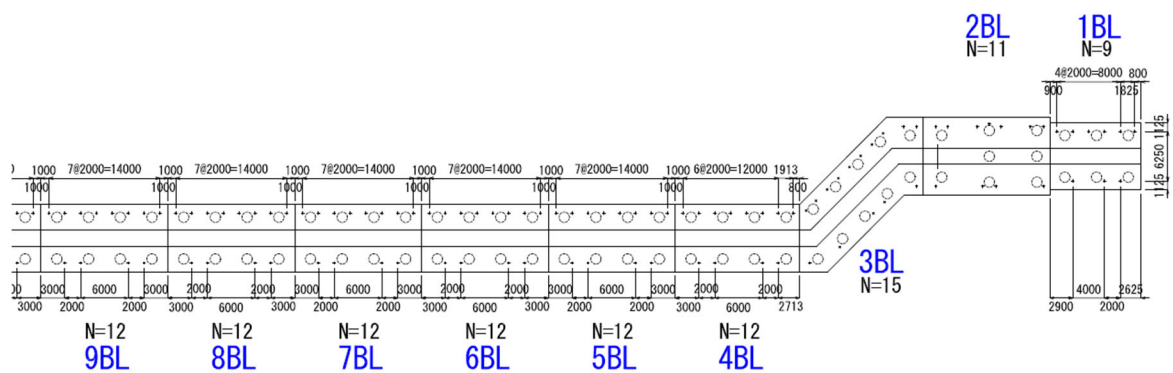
防波壁（逆 T 擁壁）の概略配筋図
